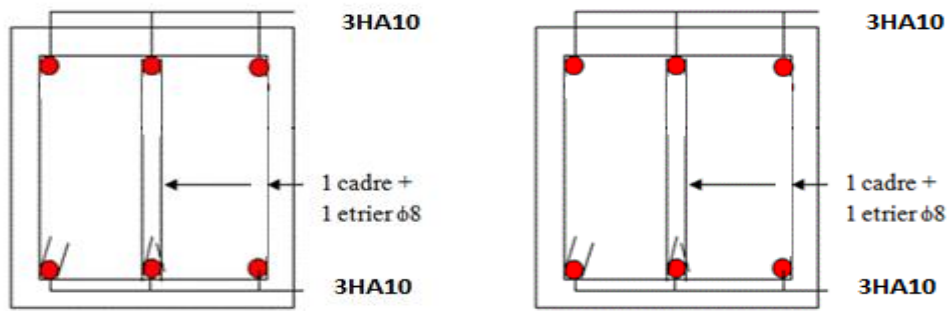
Schéma de ferrailage de la poutre de chaînage.
